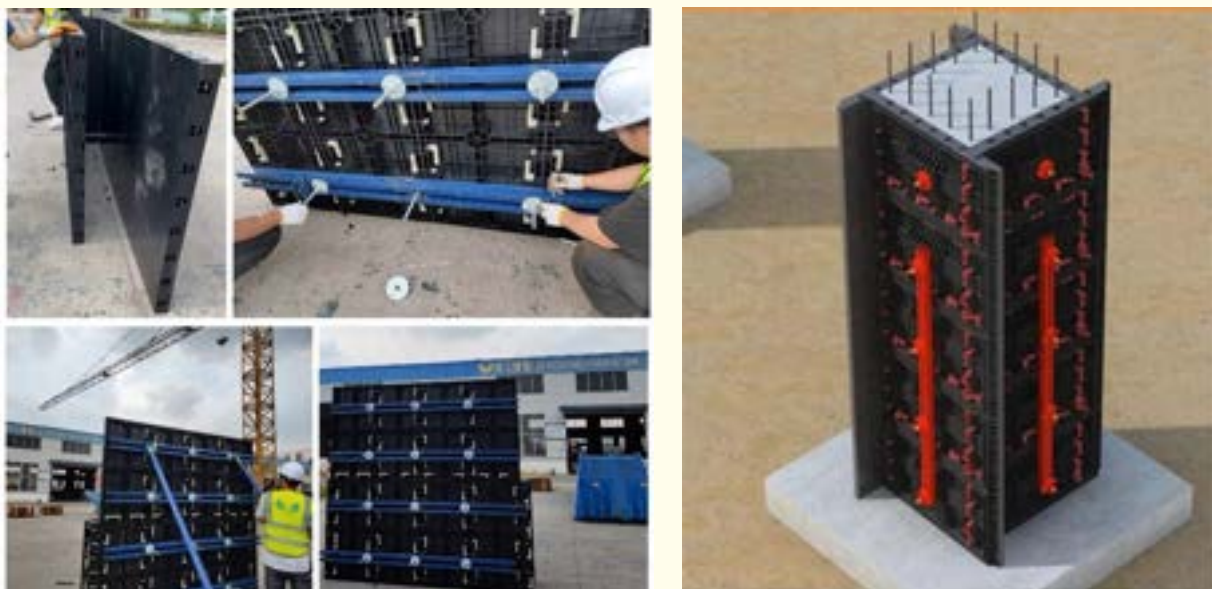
e 2. Fôrmas plásticas reutilizáveis para estruturas de concreto moldadas “in loco”.
